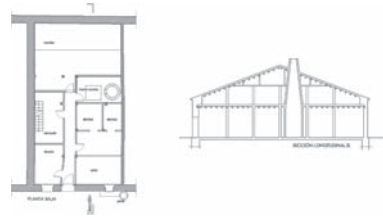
Vivienda de una planta más sobrado. Cedillo de la Torre (Segovia).
